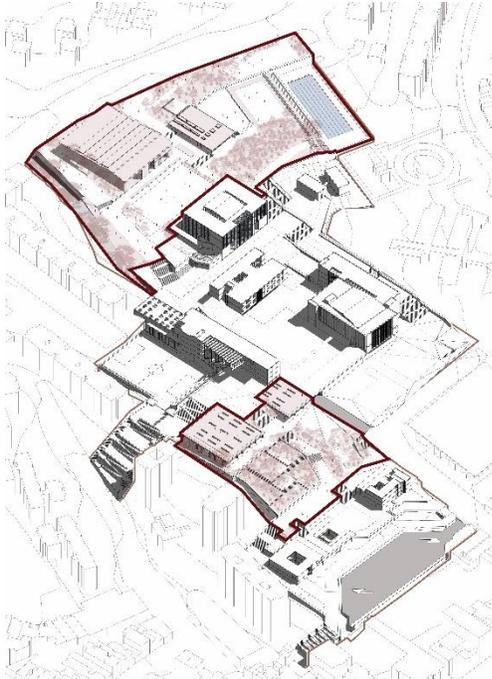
Etapa 3 constructiva. Zona cultural y Plaza de acceso.
